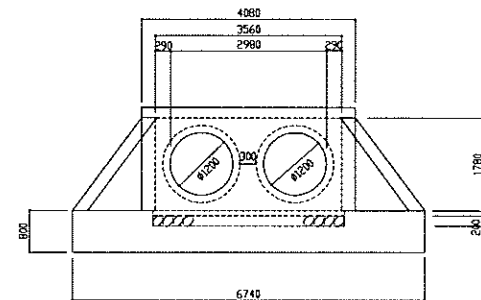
Detail et Generaux des Buses en Béton et Dalots (1/4)
